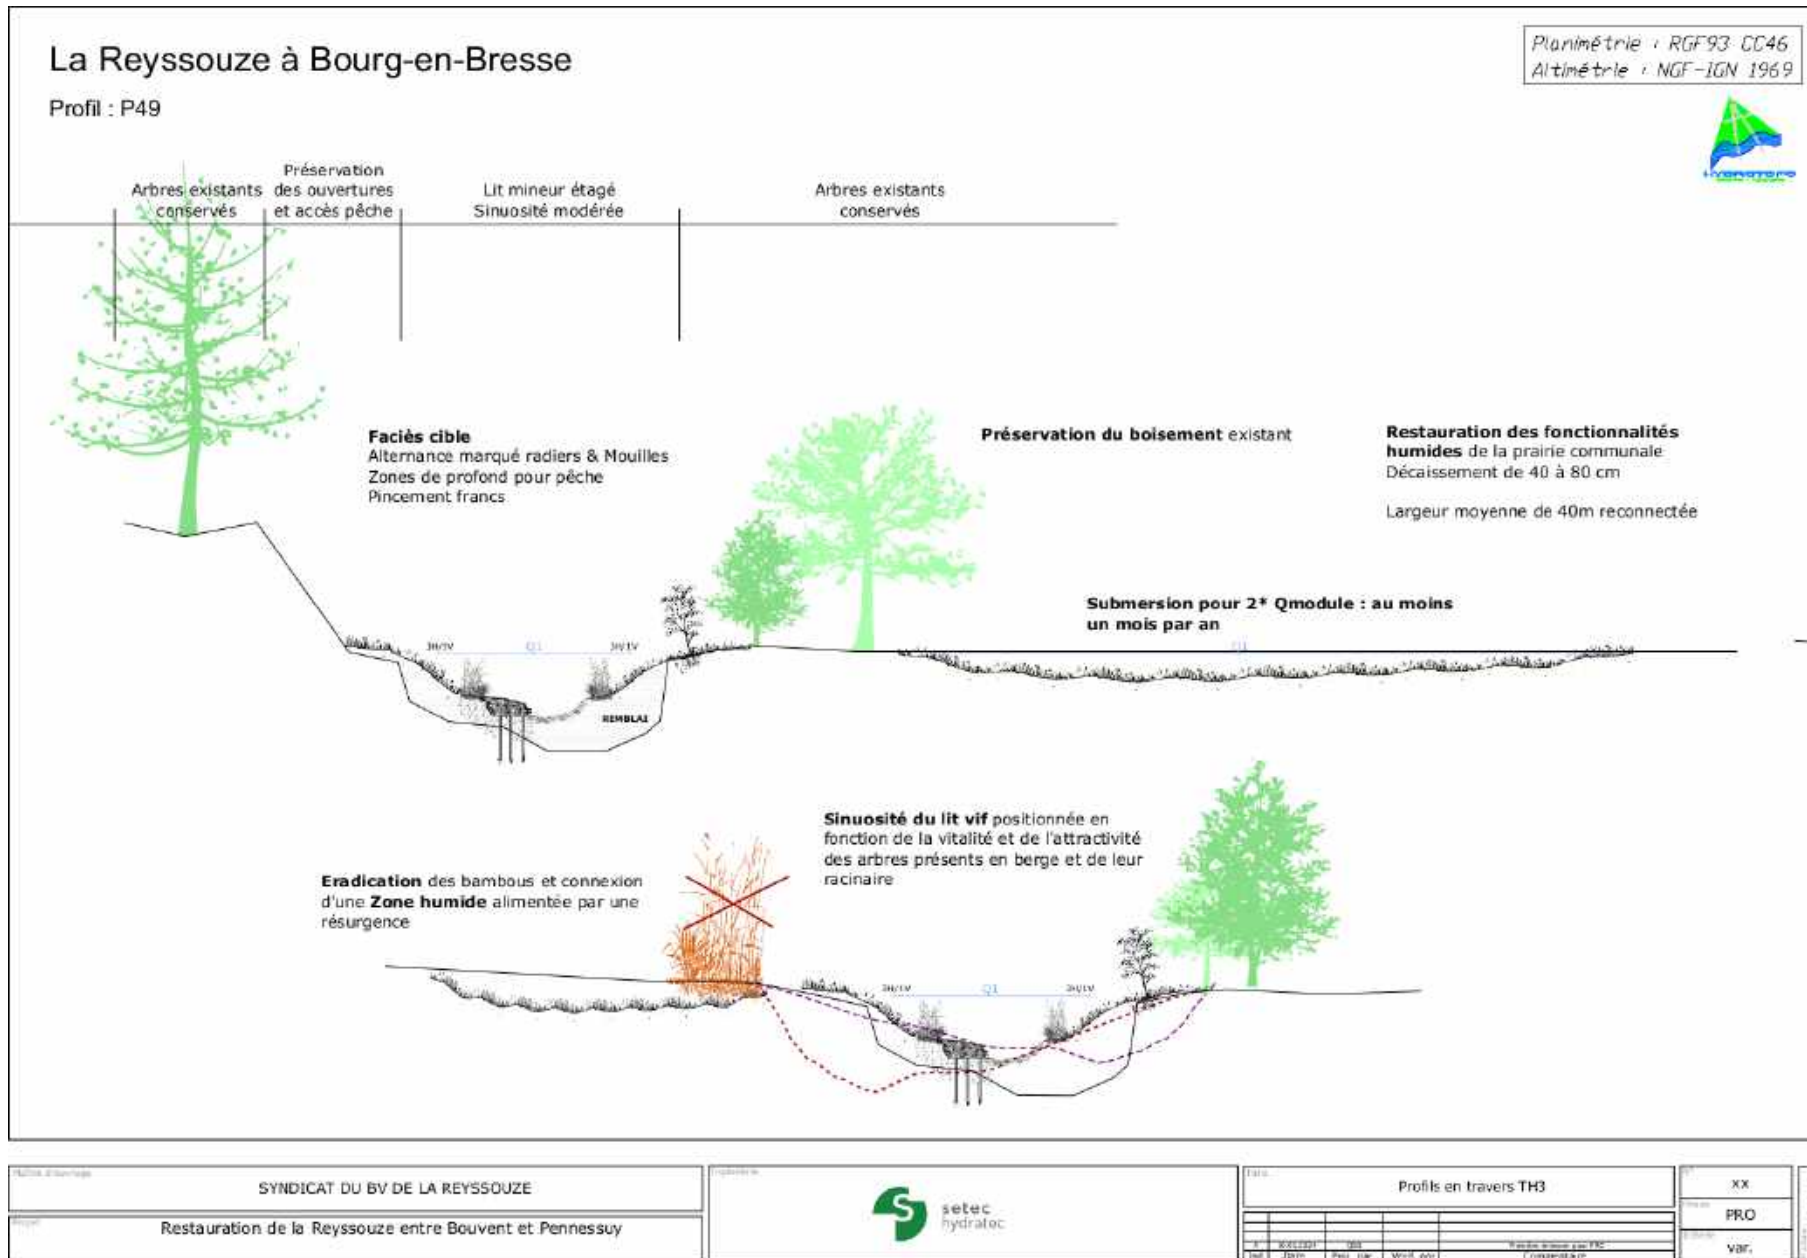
Profil en travers sur le tronçon 3 (SETEC/HYDRATEC)
